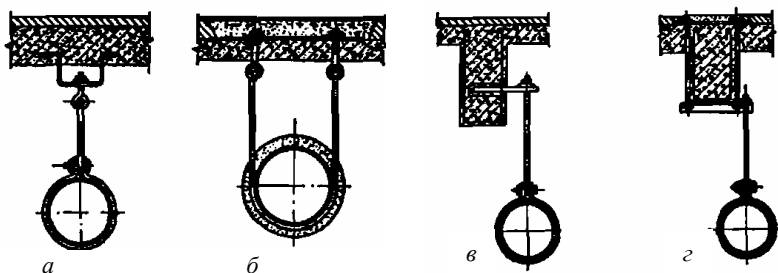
Подвесные опоры трубопроводов: а) для продольных и поперечных перемещений; б) для продольных перемещений; з) с обвязкой балки
